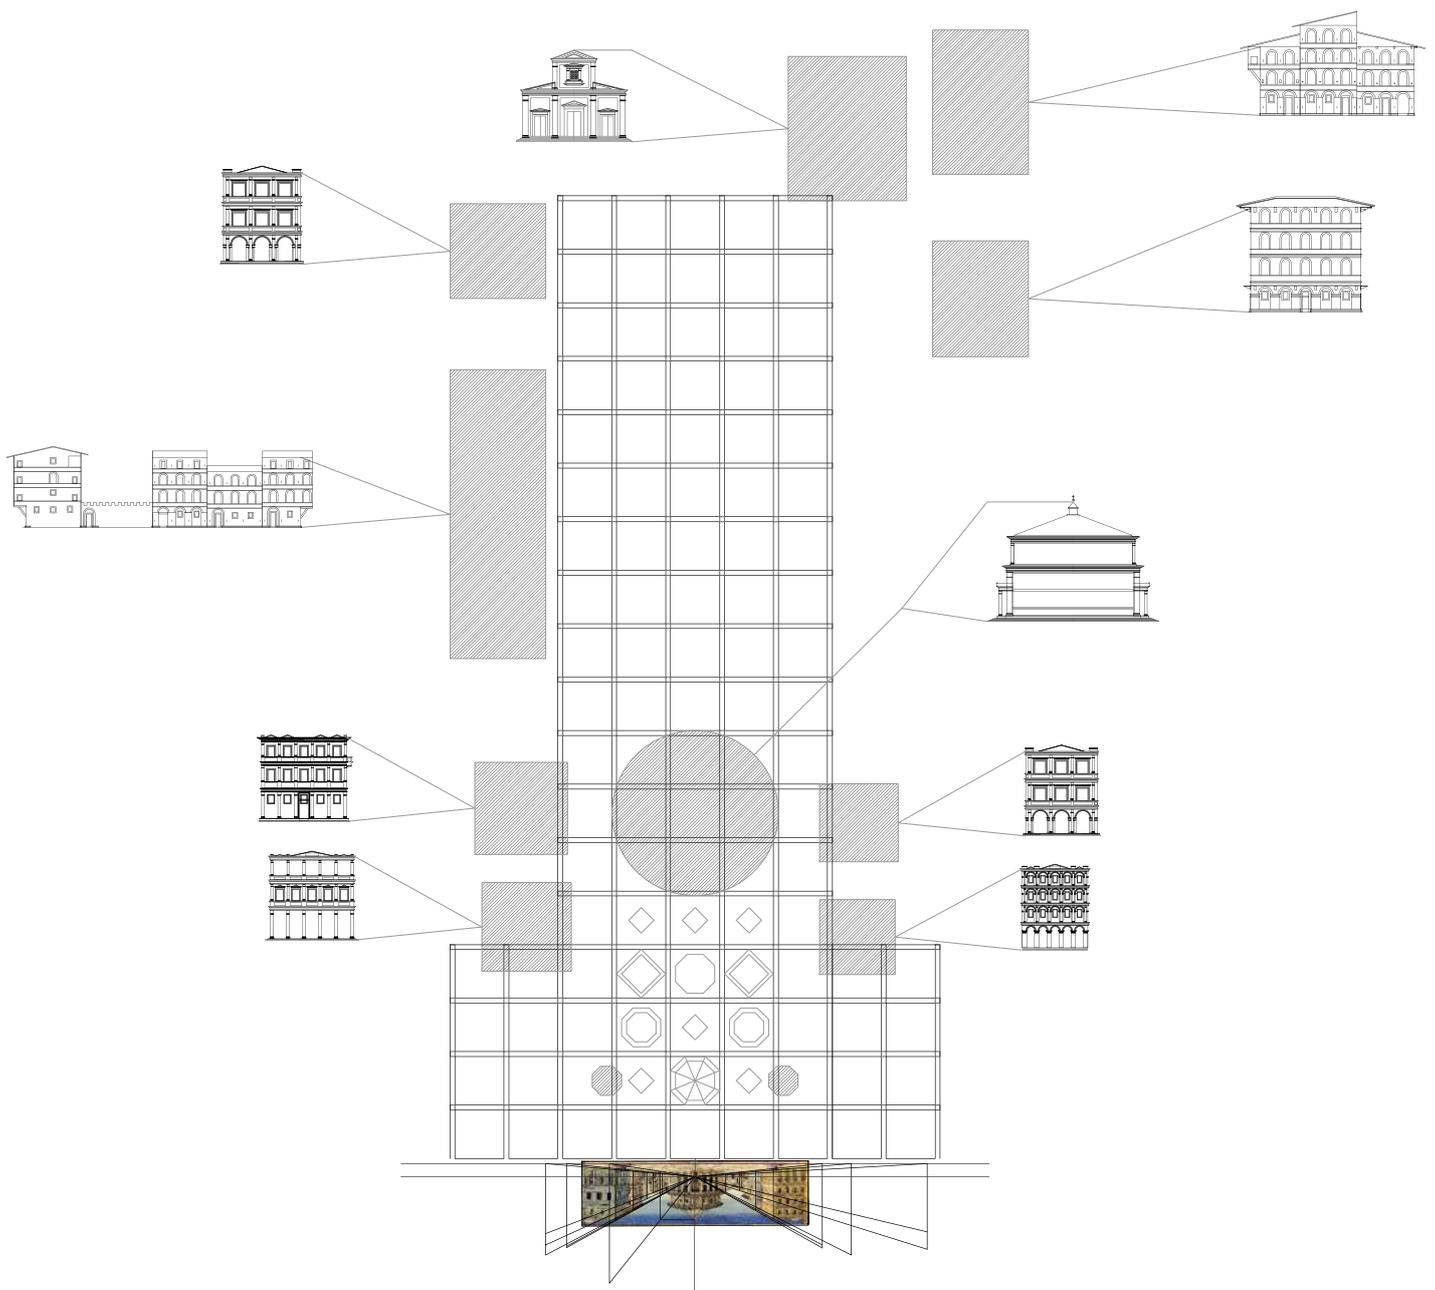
Imagen que relaciona la planta con las fachadas de referencia con la altura y la aporfundidad de la perspectiva. Producción propia.
